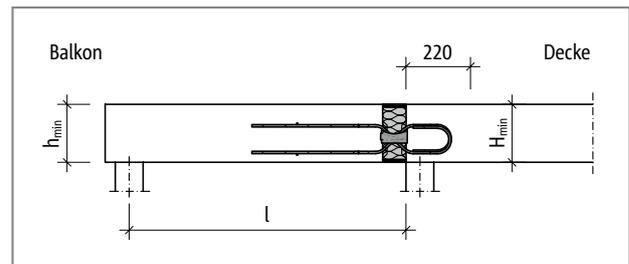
Schöck Isokorb® T Typ QL-VV4 bis QL-VV6: Statisches System
